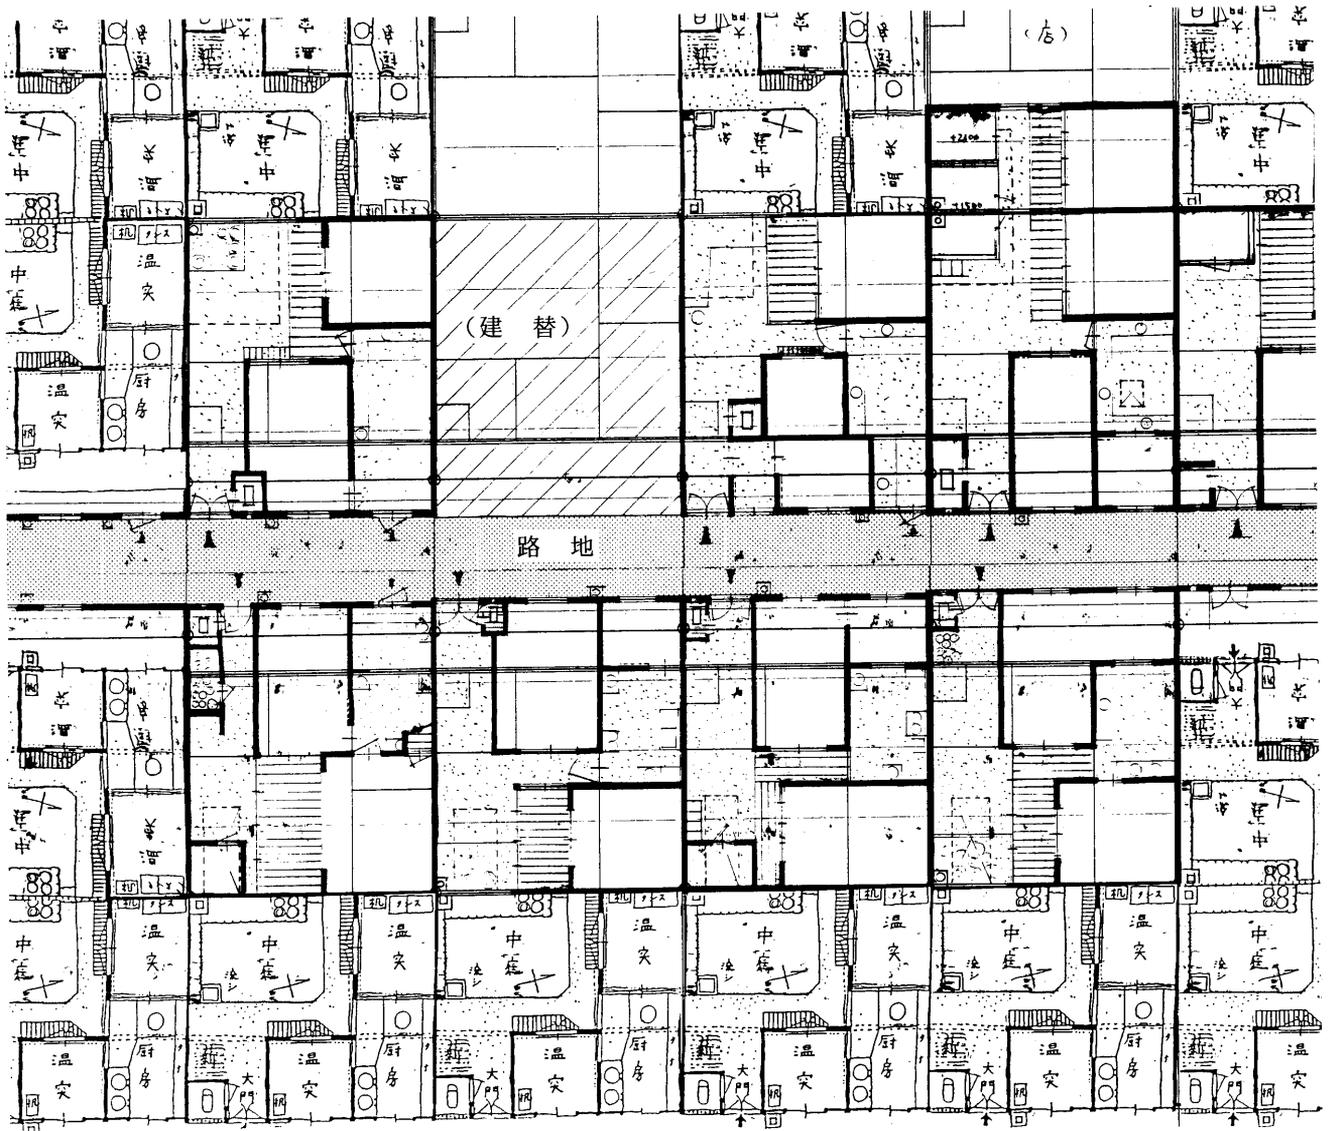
山谷洞現存住宅現況平面図 (一部分) [(注)未調査部分は原形平面を記入している。]
